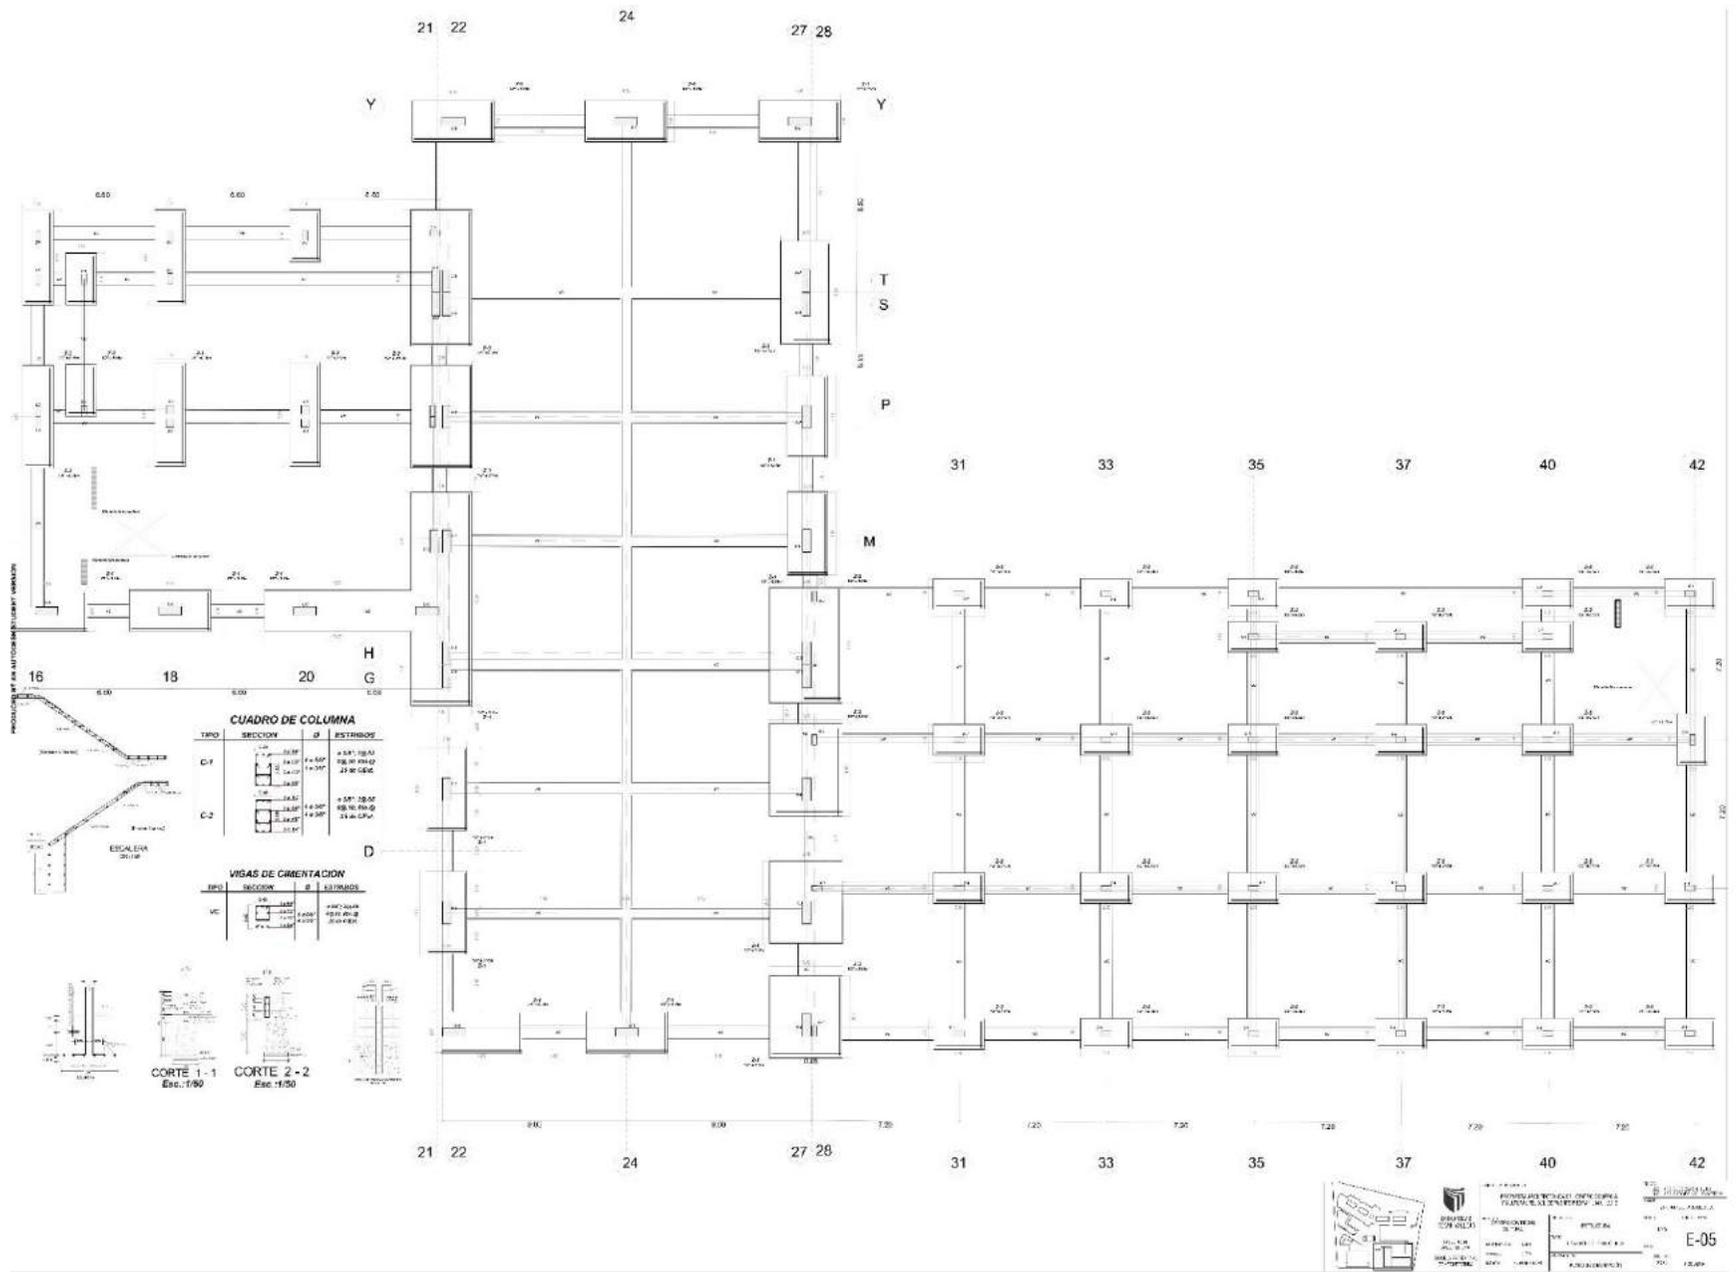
Plano E. de cimentación – zona cultural. Elaboración propia.
